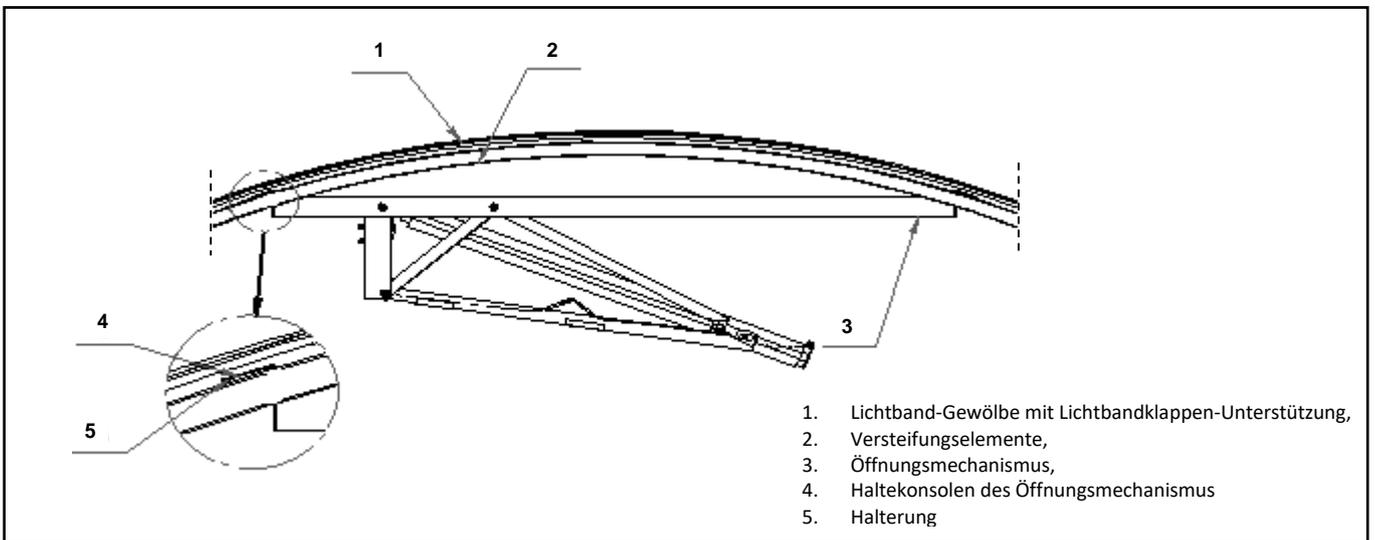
Montage des Öffnungsmechanismus - Seitenansicht
